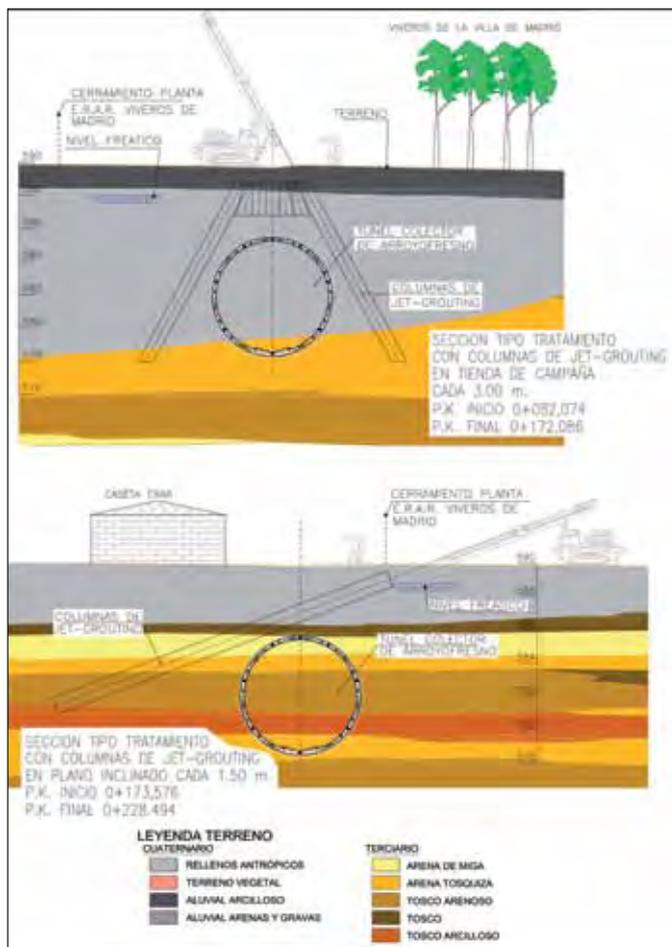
Paso junto a la depuradora de Viveros y protección de la instalación
